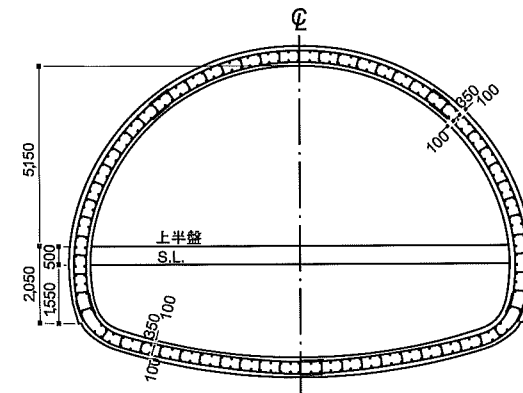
中野トンネル覆工鉄筋コンクリート配筋図
